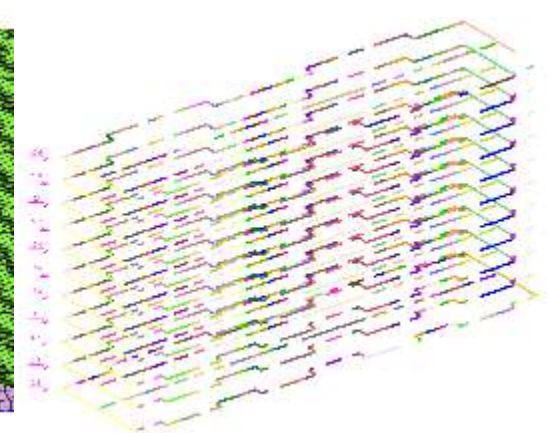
Розрахункові рівні кладки всієї будівлі
